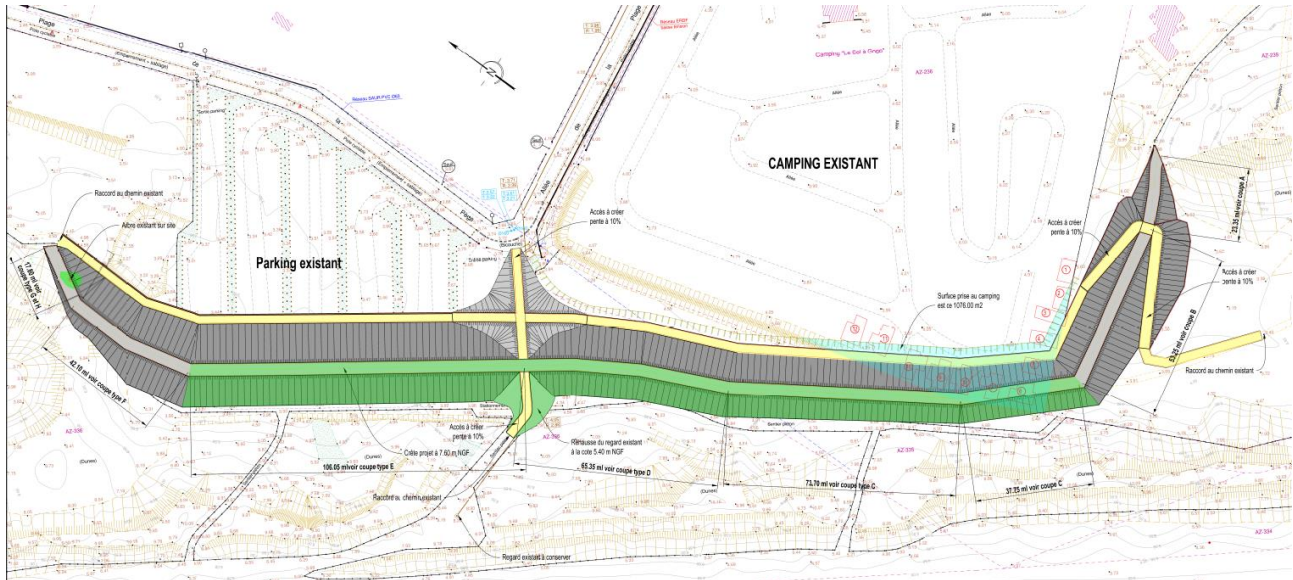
Implantation des cheminements (en jaune sur le plan)
